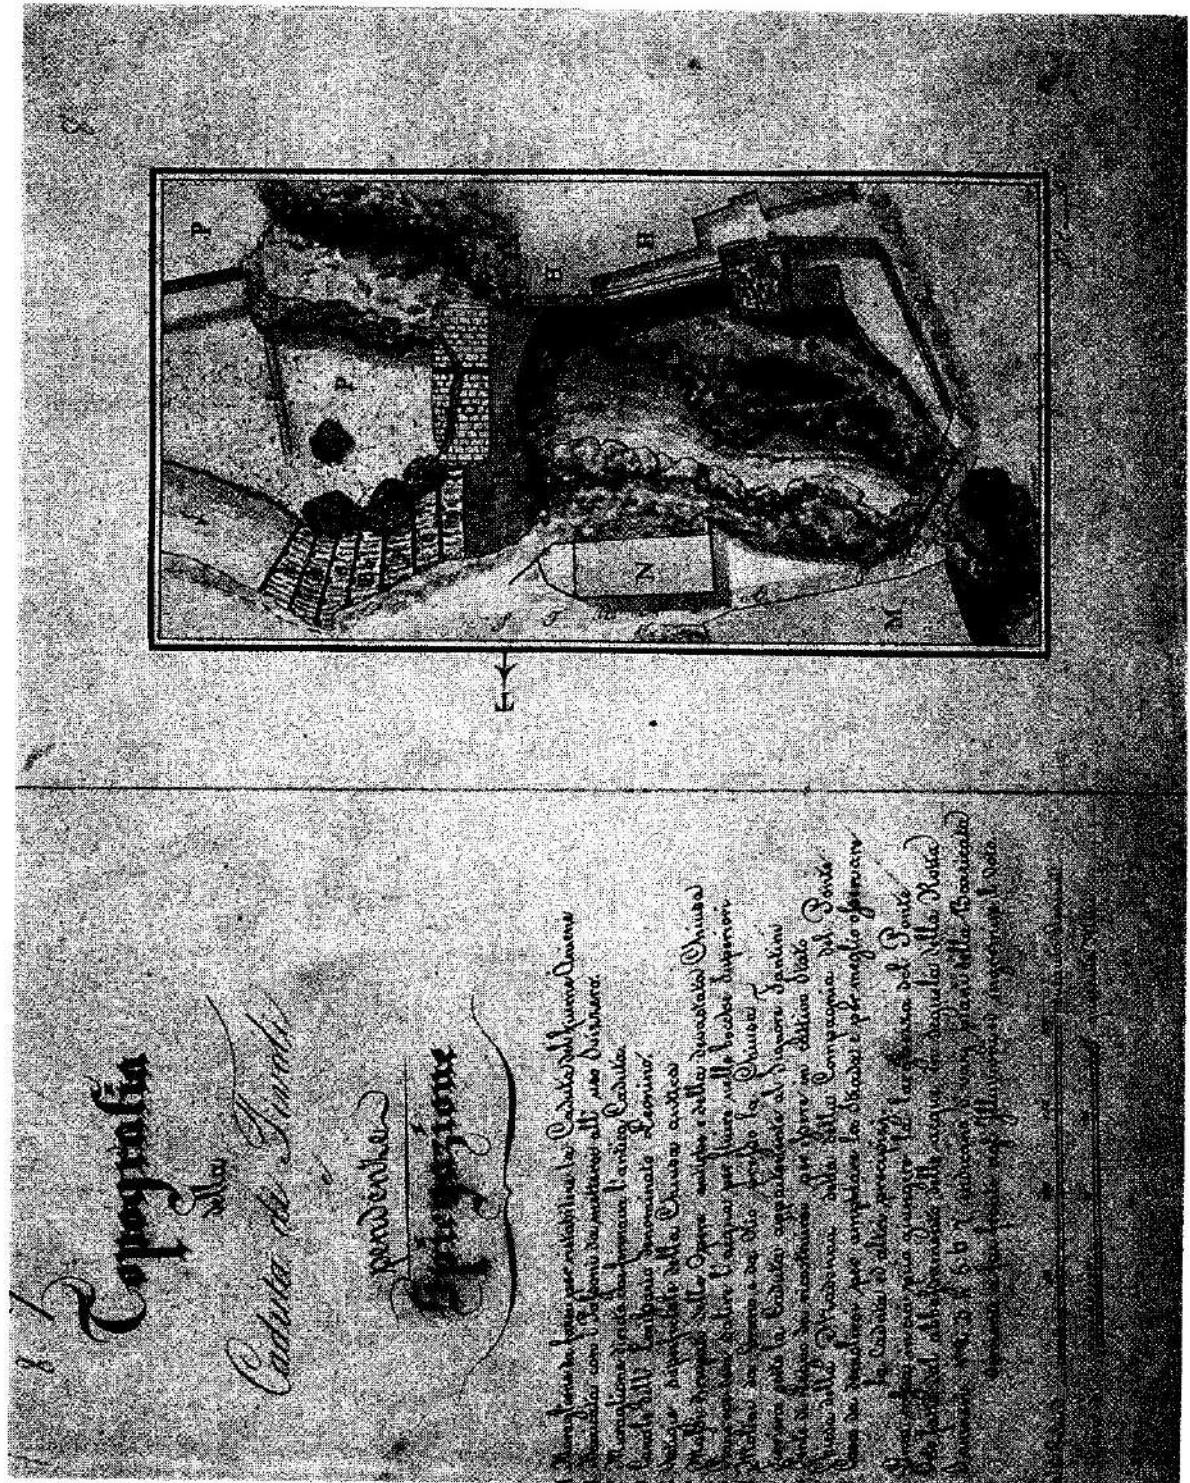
Bibl. Casanatense, *Raccolta delle piante originali sui grandi lavori eseguiti all'Aniene*, n° 7, Pianta di progetto per la sistemazione definitiva dell'Aniene di Paolo Campili.
